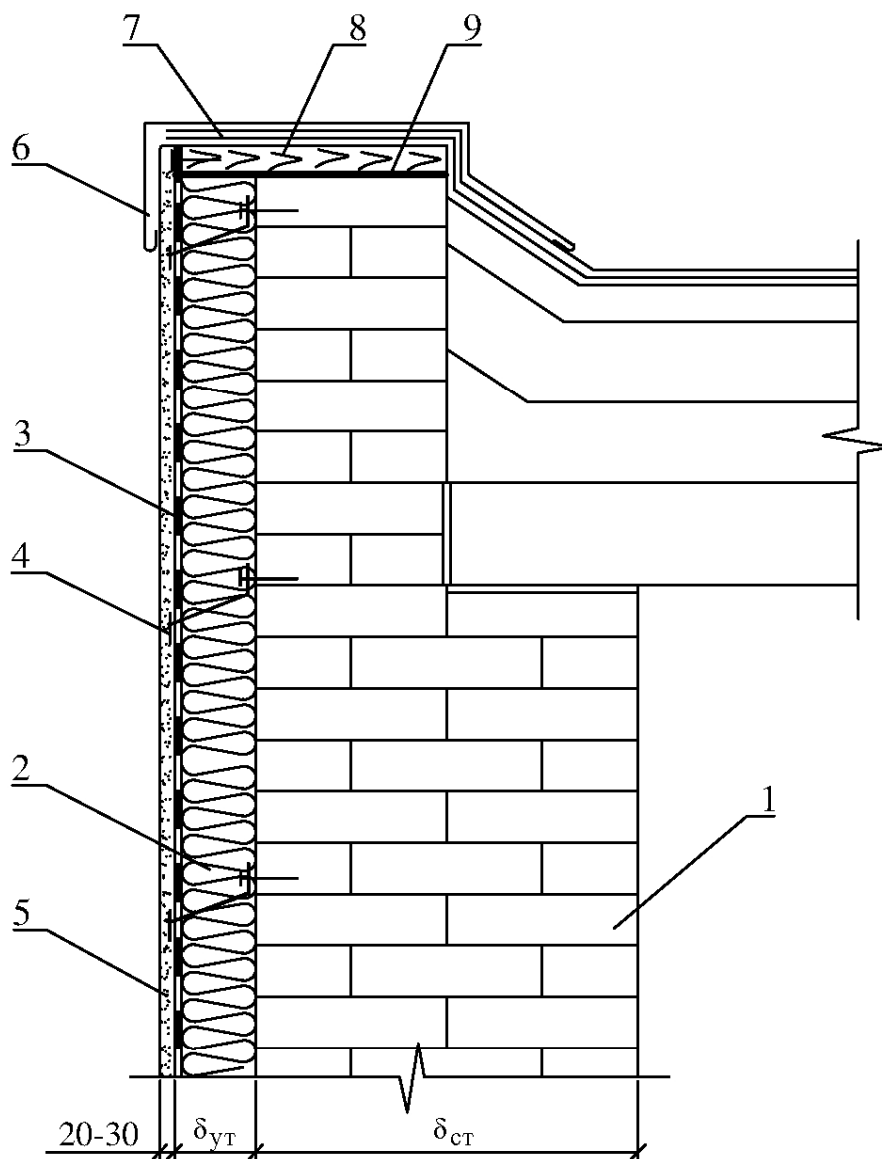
Крепление теплоизоляционной конструкции подвижным элементом крепления.
